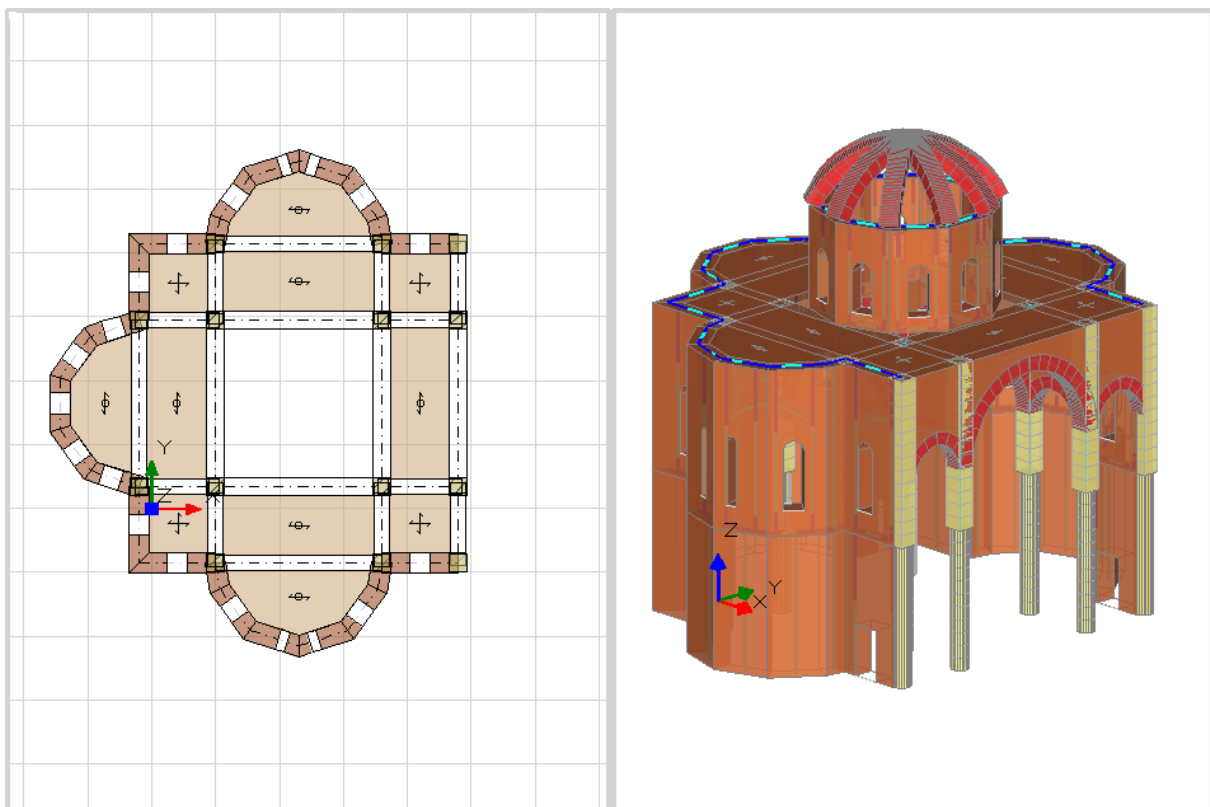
Basilica con Cupola, vista in Pianta ed Assonometria
